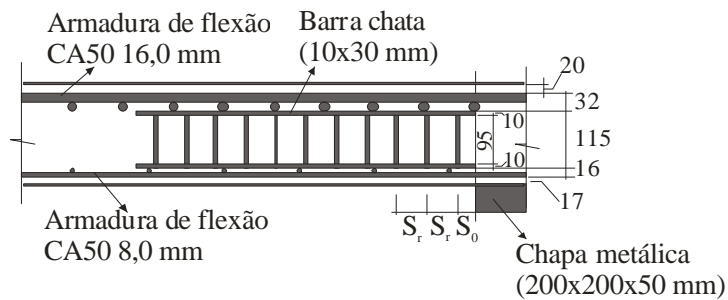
Desenho esquemático do posicionamento da armadura de cisalhamento utilizado por Trautwein (2006)
